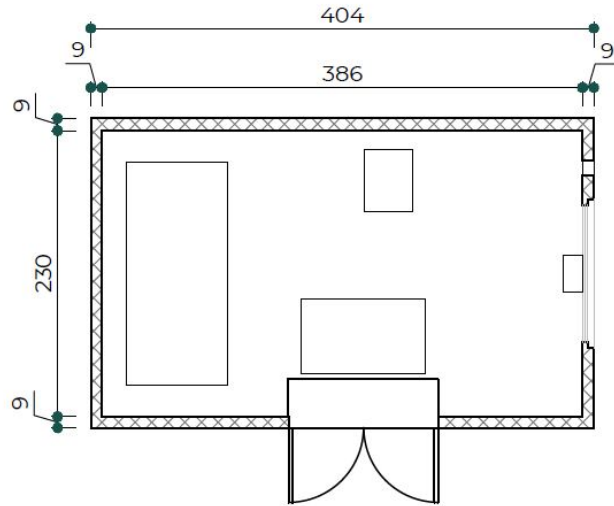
Vista della pianta della nuova cabina in progetto.
